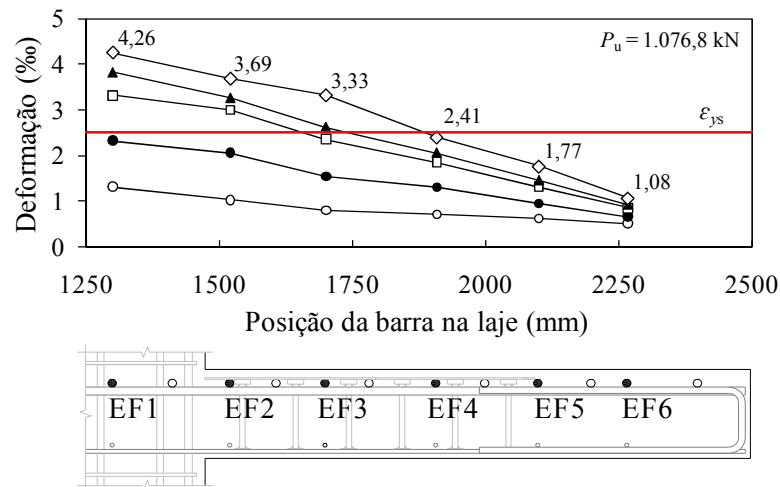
Deformações nas armaduras de flexão da laje LC03
